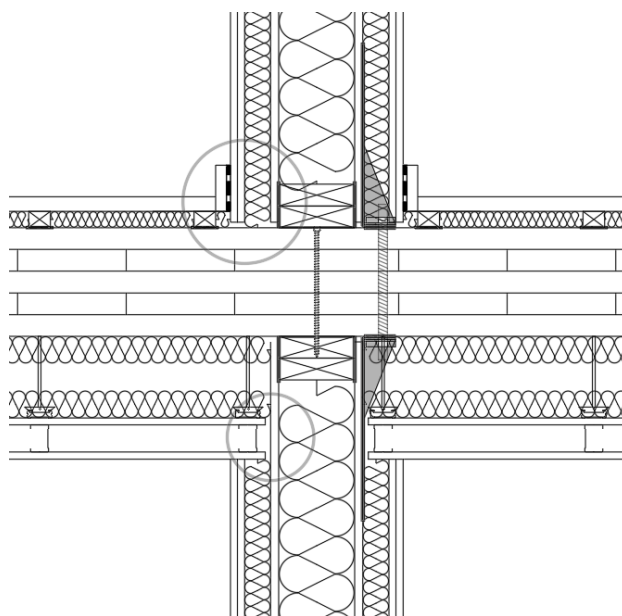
Detalhe da separação rígida entre os componentes de acabamento dos elementos construtivos. Exemplo: Par_Int_Est_TF e Pav_Int_CLT
